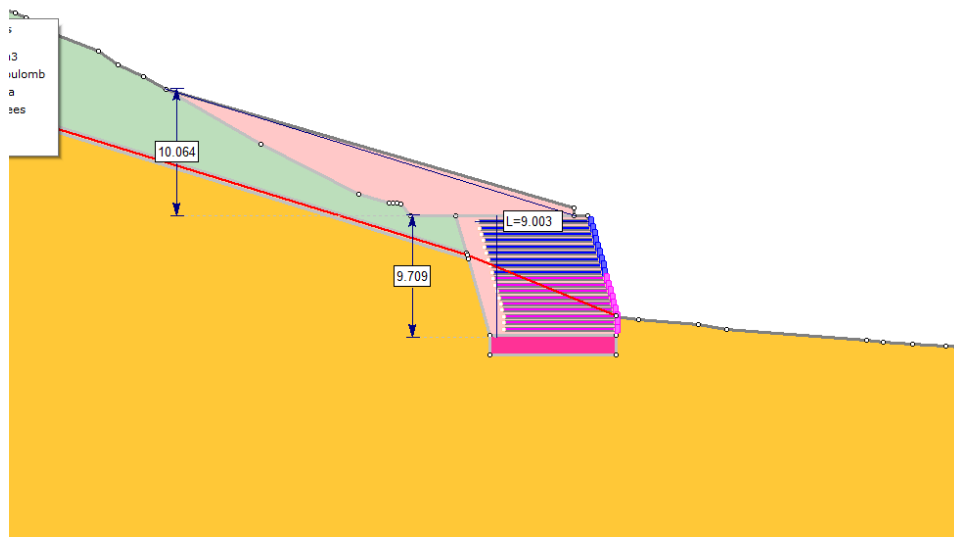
Modelo con muro en tierra armada perfil 1
